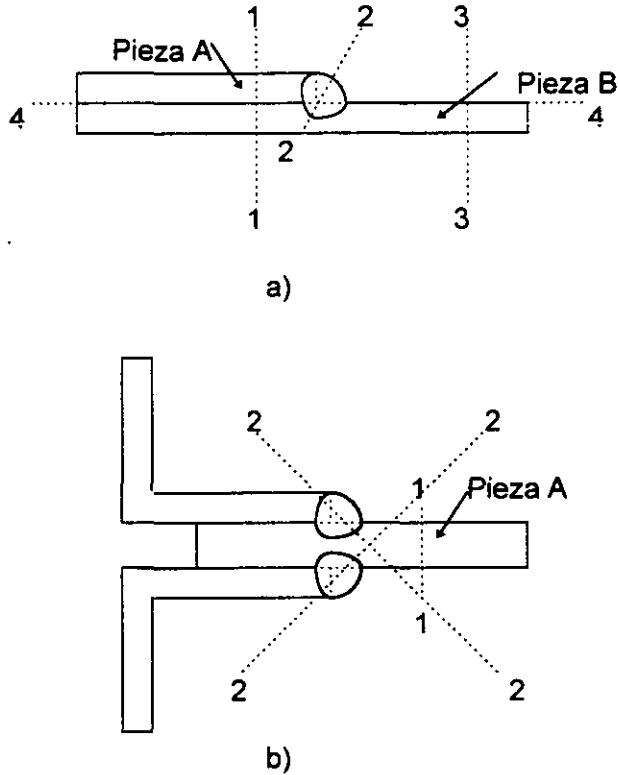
Planos de cortante para juntas con soldaduras de filete cargadas longitudinalmente.
